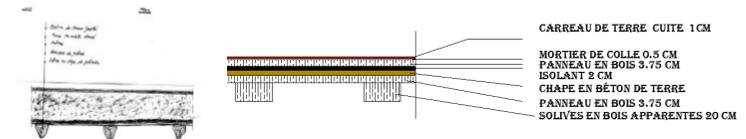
/36: détail plancher en bois, source : planchers traditionnels en Algérie ; auteur.
